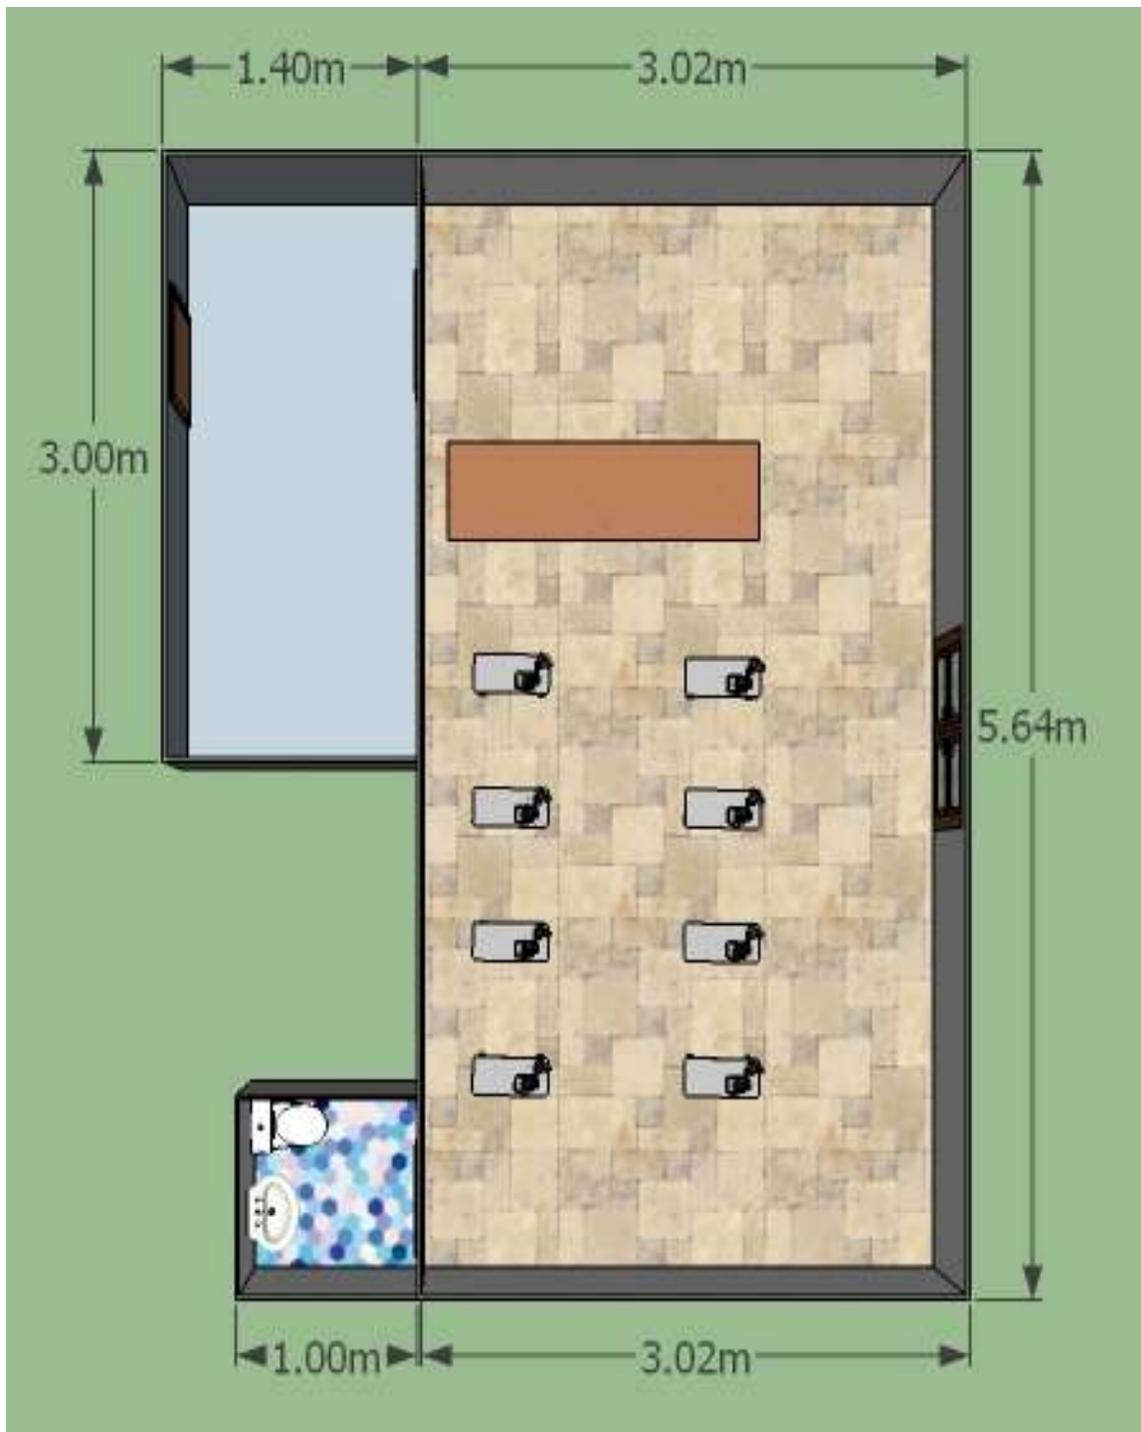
Propuesta distribución de planta ampliada (vista planta).
